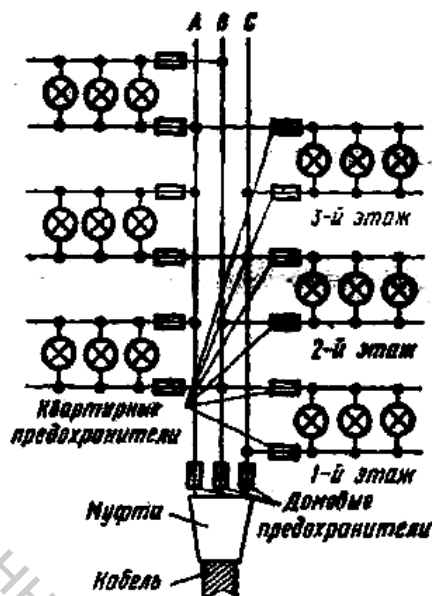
Схема трехпроводной осветительной сети при соединении фаз нагрузки треугольником
